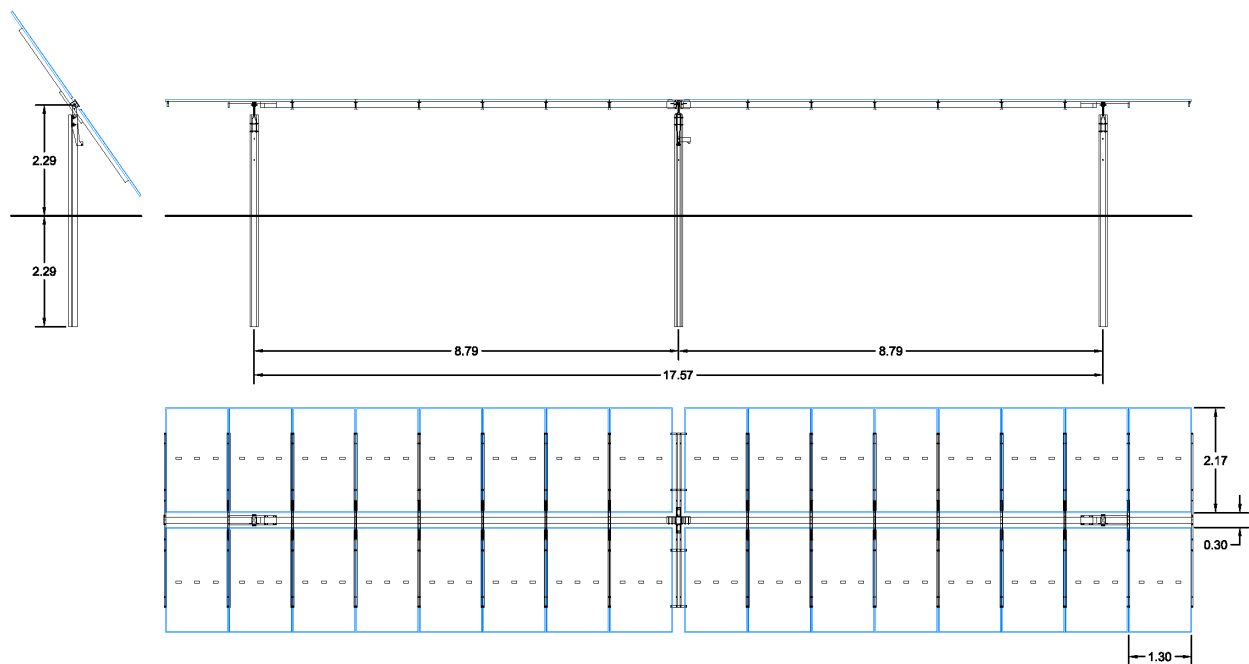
Pianta, sezione e prospetto quotati del tracker e dei moduli.
